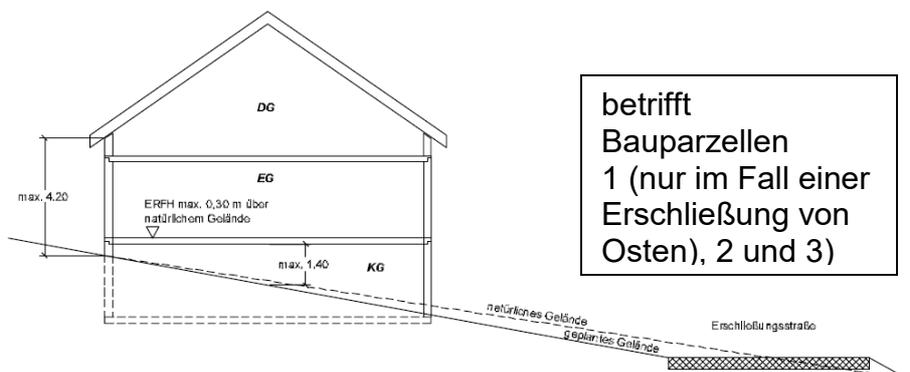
Lage des Baugeländes (Wohnhaus) höher als Erschließungsstraße – Erläuterungsskizze zur Punkt 2.2.1 a) der Satzung
